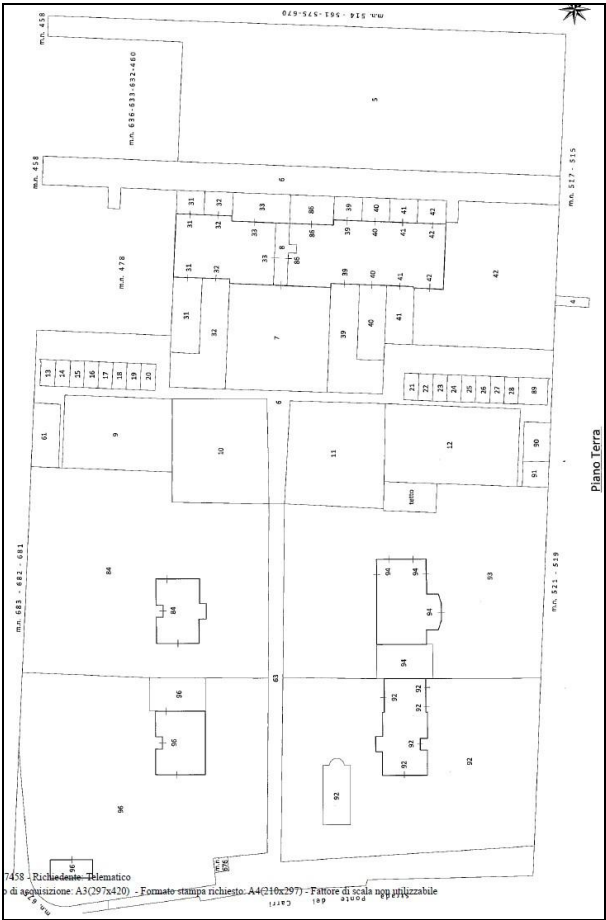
Planimetria subalterni piano terra ([Allegato N.4](#))
